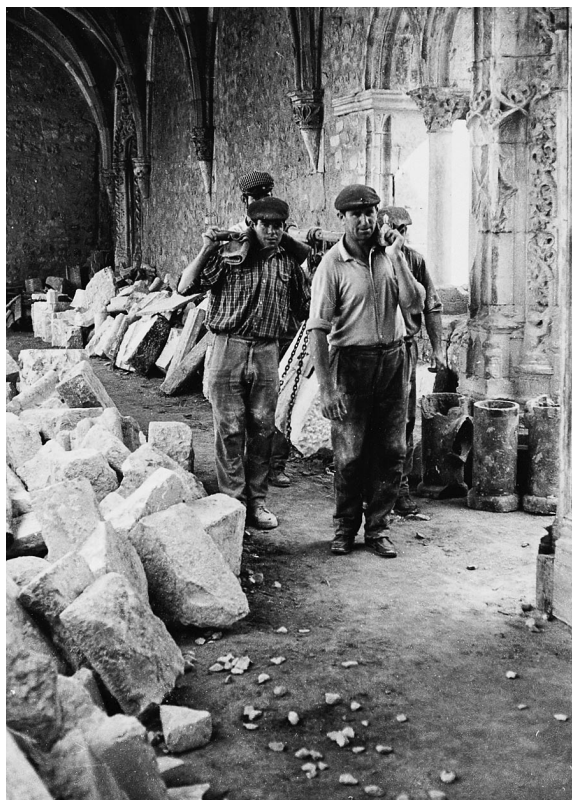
Transporte de antigas lajes do pavimento do Convento de S. Francisco de Santarém durante a campanha de restauro do final dos anos 60. Arquivo da DGEMN, proc. 491.
